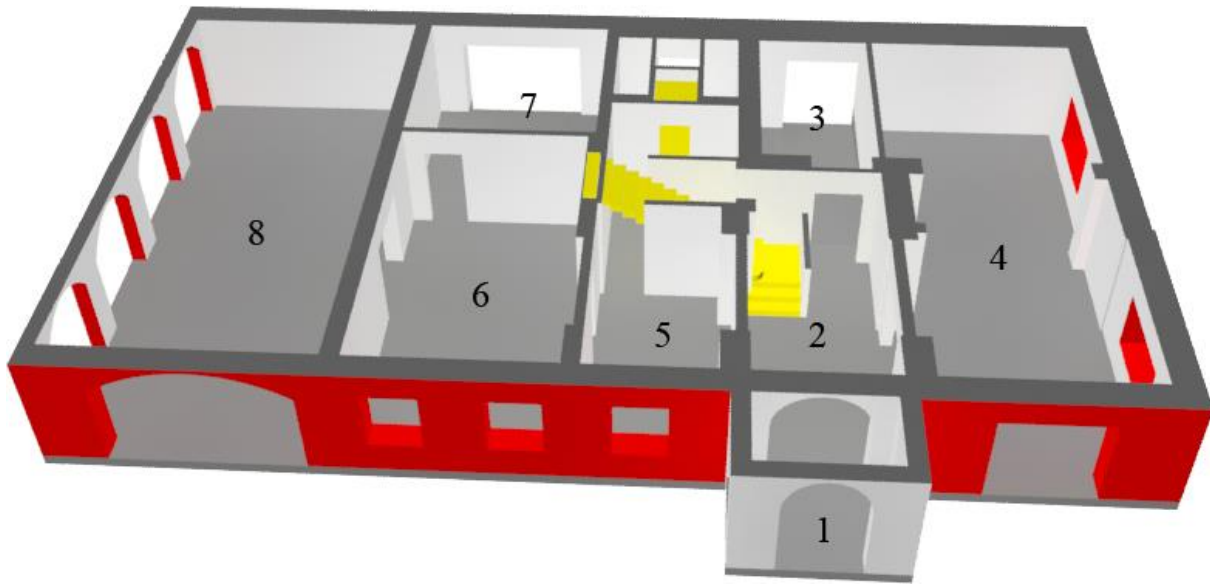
Distribución planta baja (Fuente: Propia)
